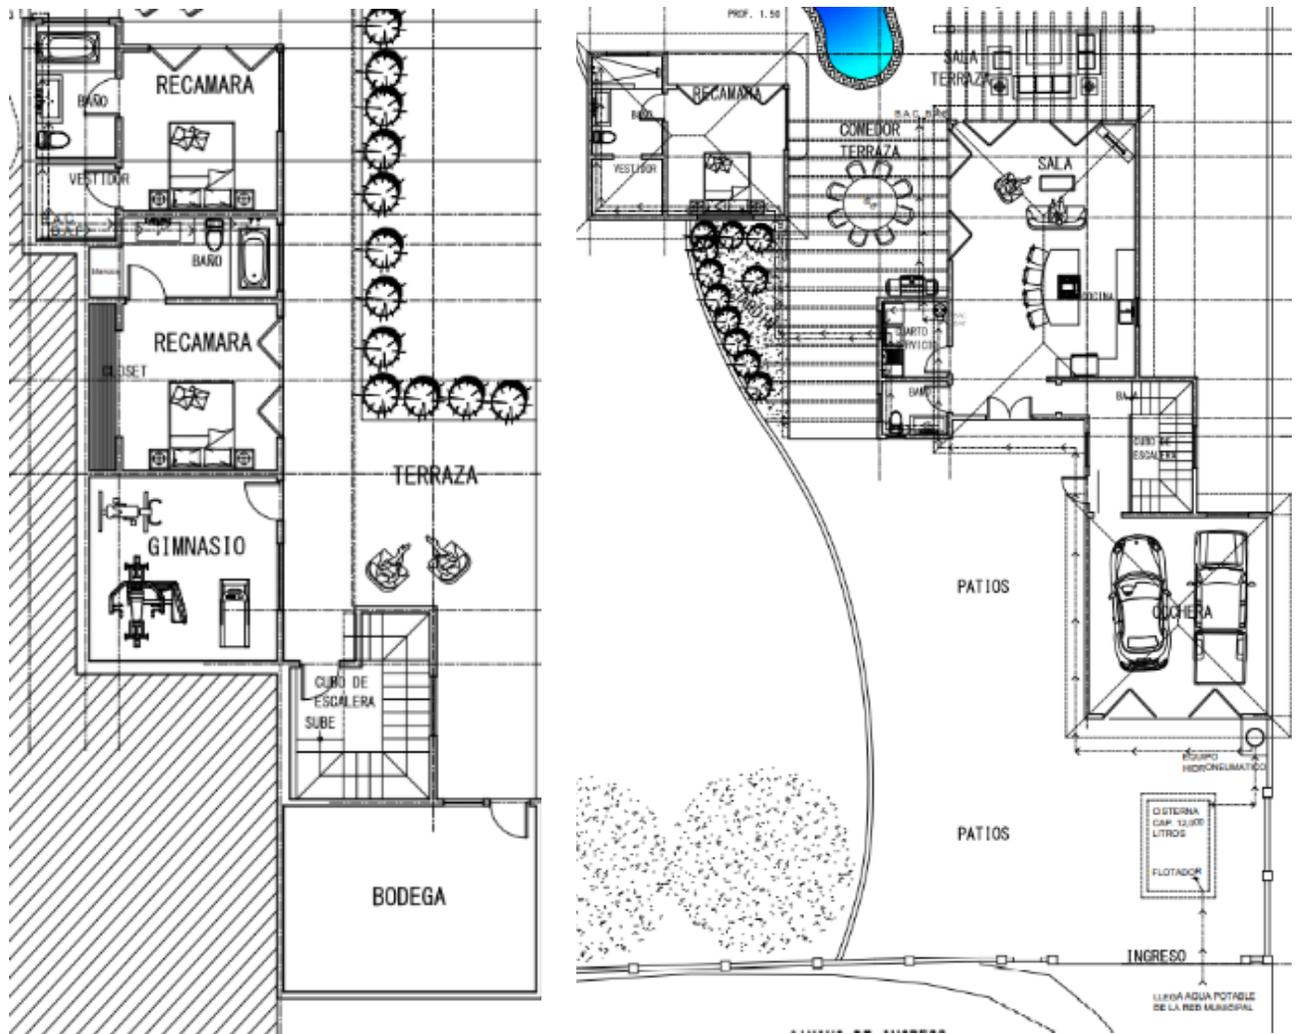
Planta de la instalación hidráulica, Izquierda Sótano, Derecha Planta Baja
